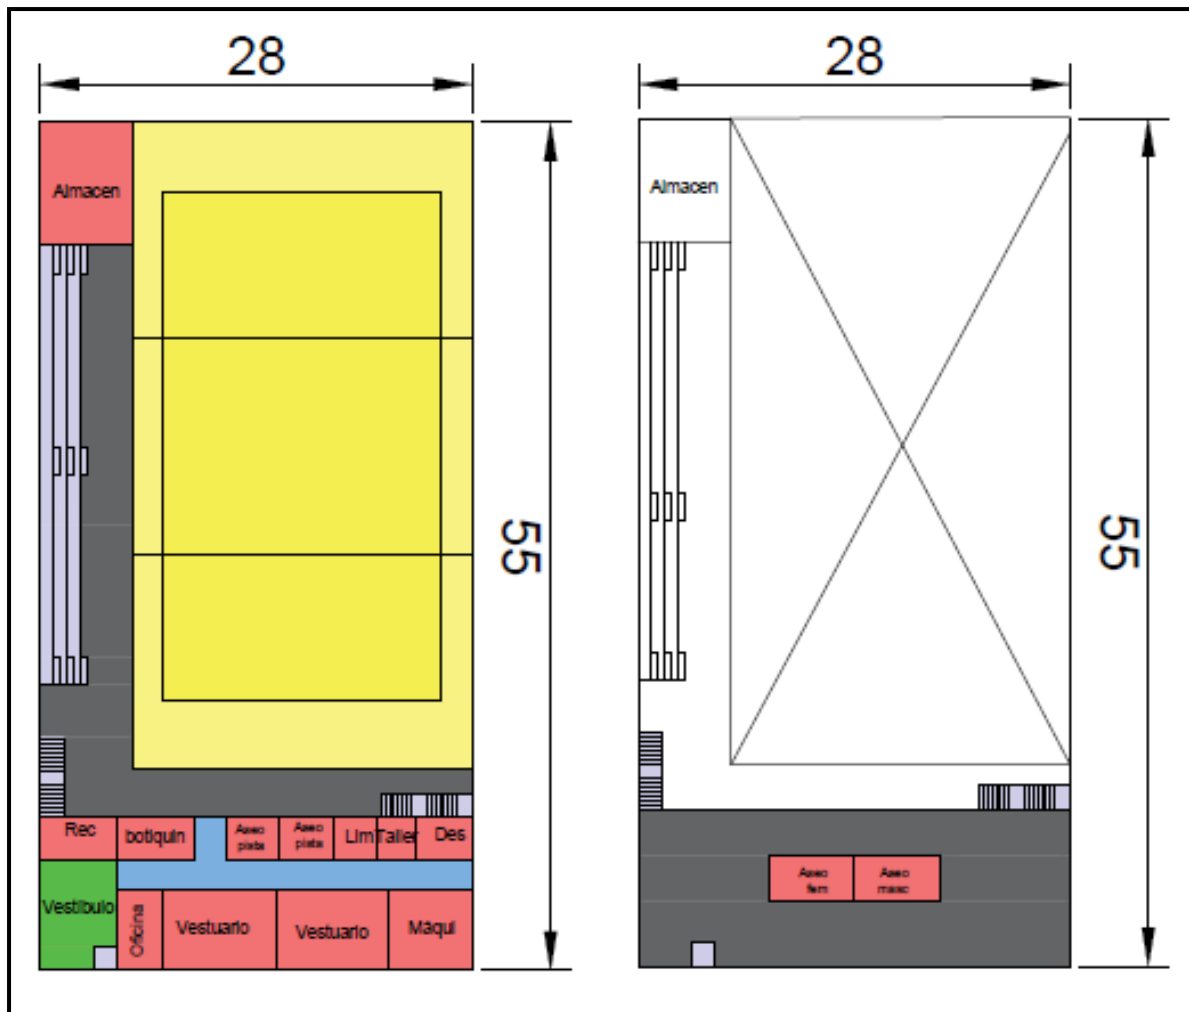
Distribución de los espacios de la alternativa 2. Planta baja (izquierda) y Planta 1 (derecha). (Fuente: Elaboración propia).
